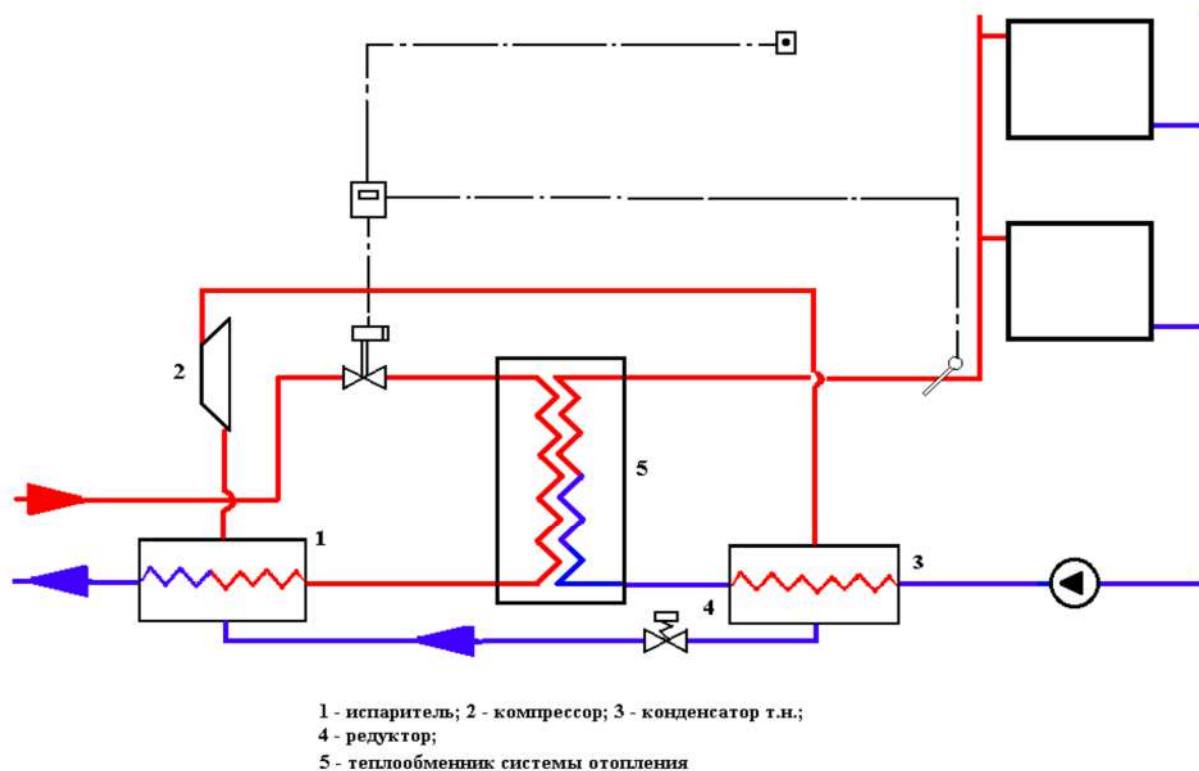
Схема теплового пункта с тепловым насосом с конденсатором на обратном трубопроводе системы отопления
